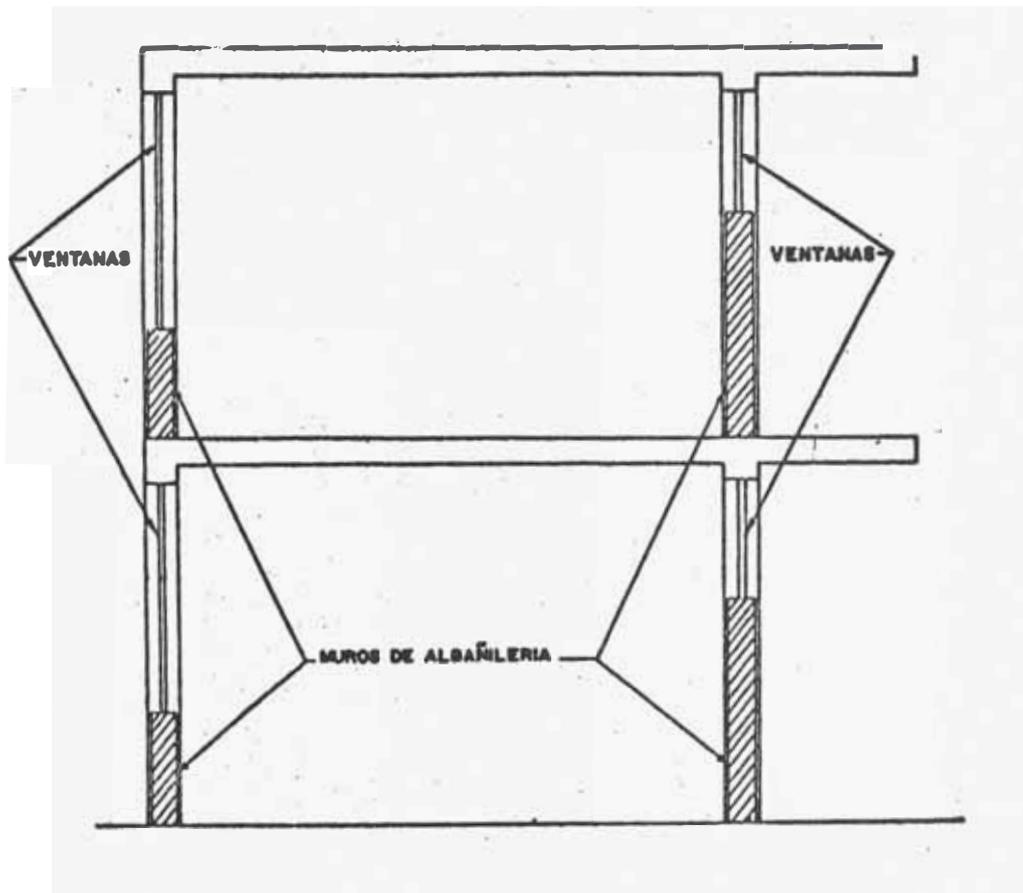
SECCION TRANSVERSAL DE ESTRUCTURA TIPICA DE ESCUELA.
